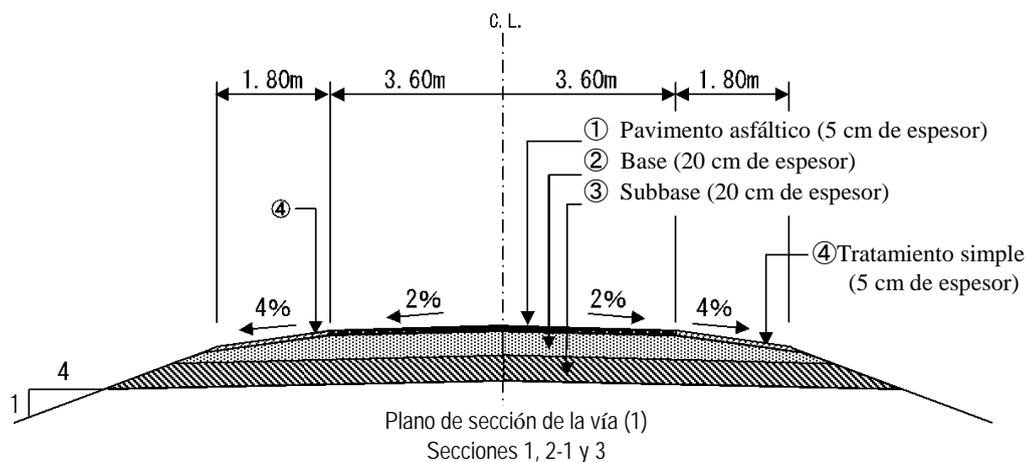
Estructura del pavimento de la Carretera Acoyapa-San Carlos
